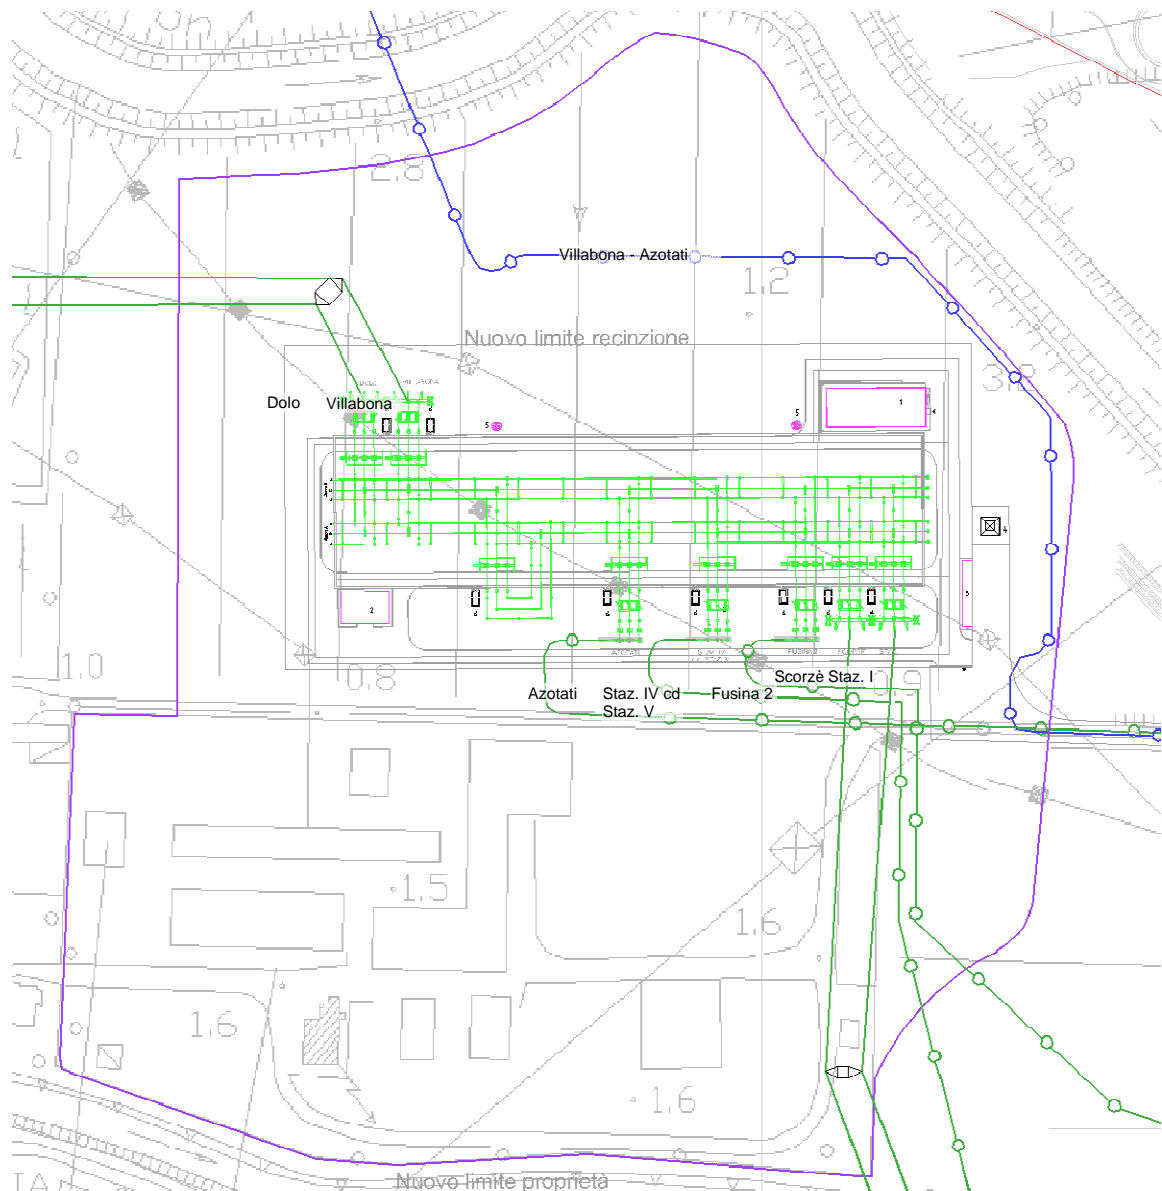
Planimetria S.E. Malcontenta. In verde i collegamenti a 220 kV e in blu il collegamento a 132 kV.
